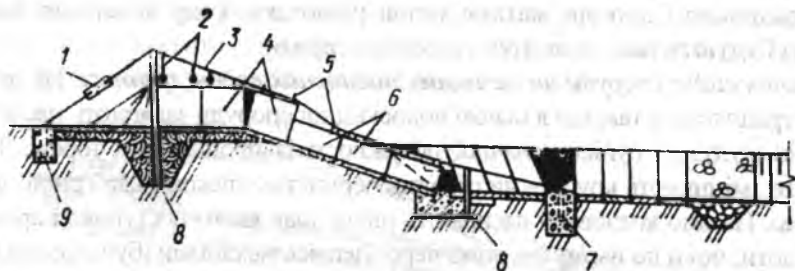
Швидкотік вантової конструкції на ґрунтах, які просідають:
